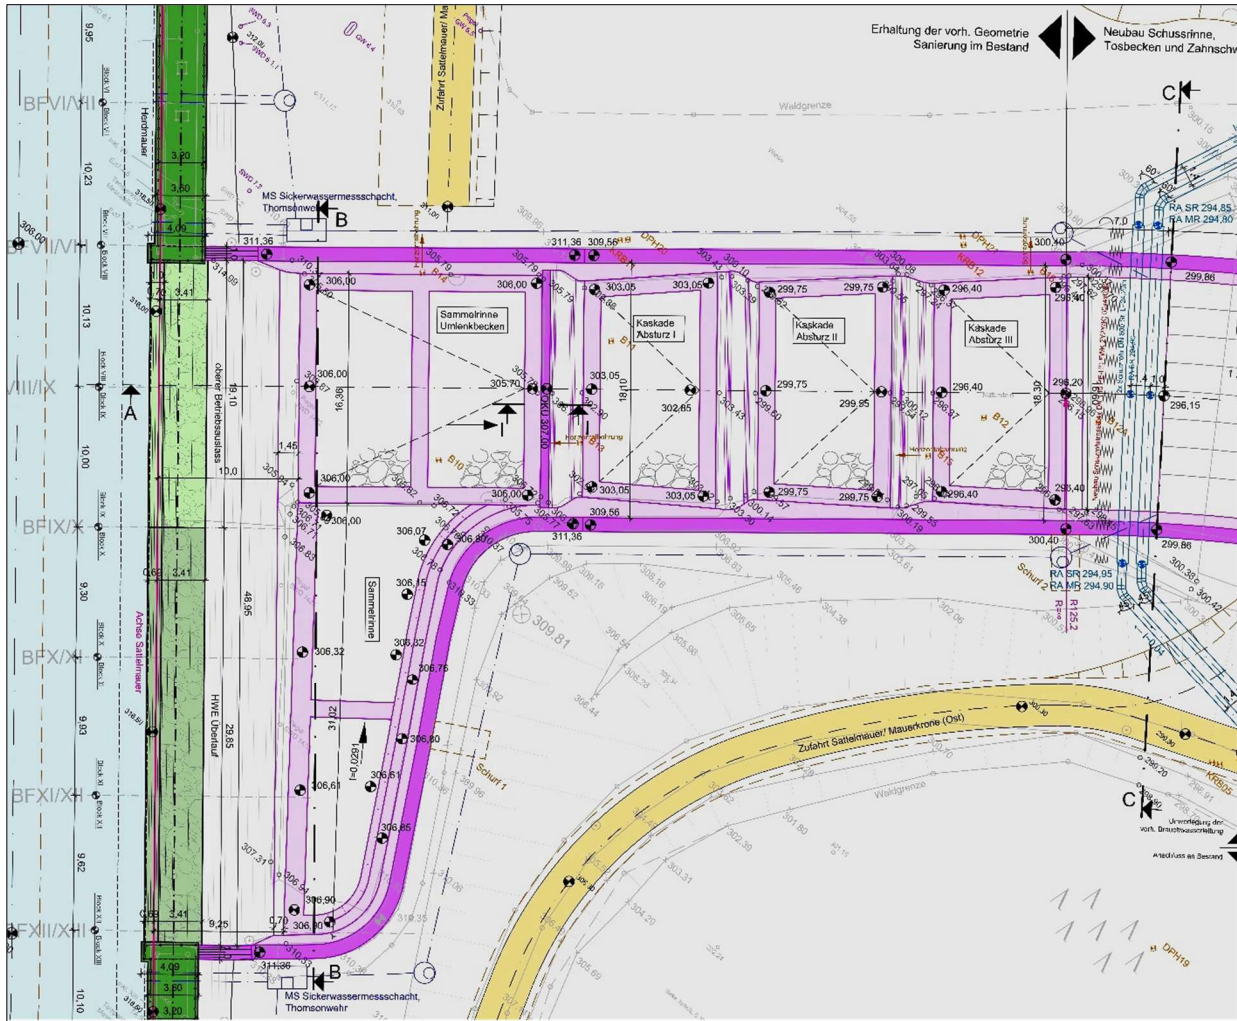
Variante A1/B1; HWE - oberer Abschnitt-Draufsicht; Ausschnitt aus Plan 423 HWE-Grundriss, Schnitt A
